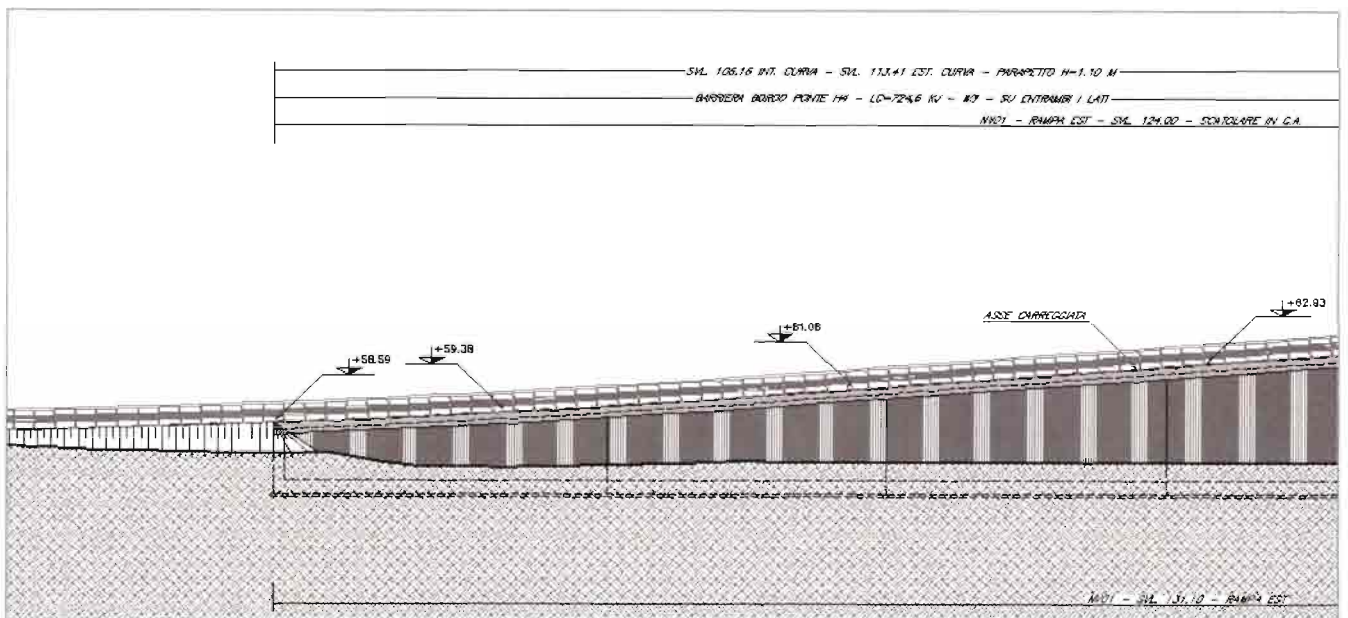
Sezione longitudinale - rampa Est, stralcio 2
